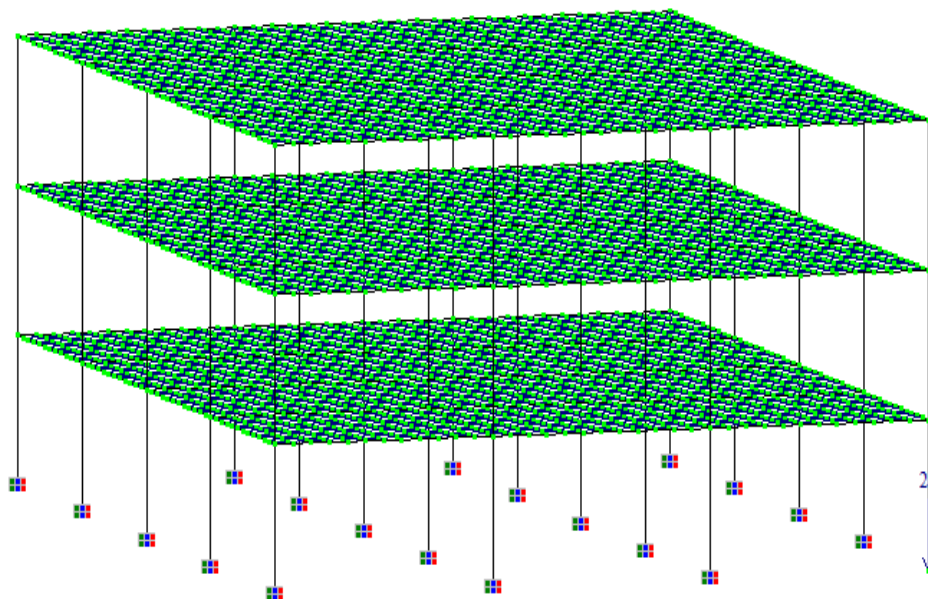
Schéma illustratif du modèle d'étude du bâtiment avec planchers sans hourdis à 3 niveaux avec un chargement vertical sur le poteau d'angle
